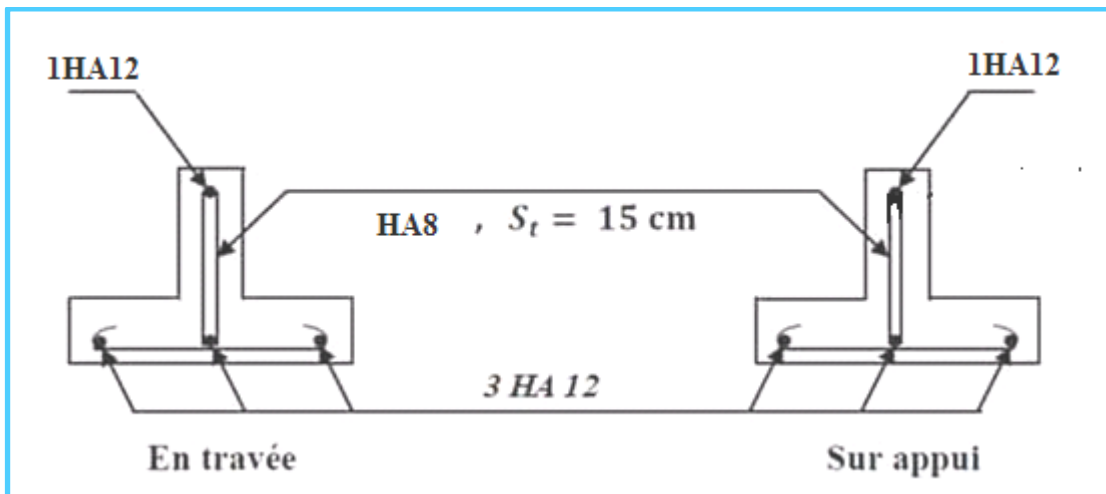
Schéma de ferrailage de plancher étage courant et terrasse.
